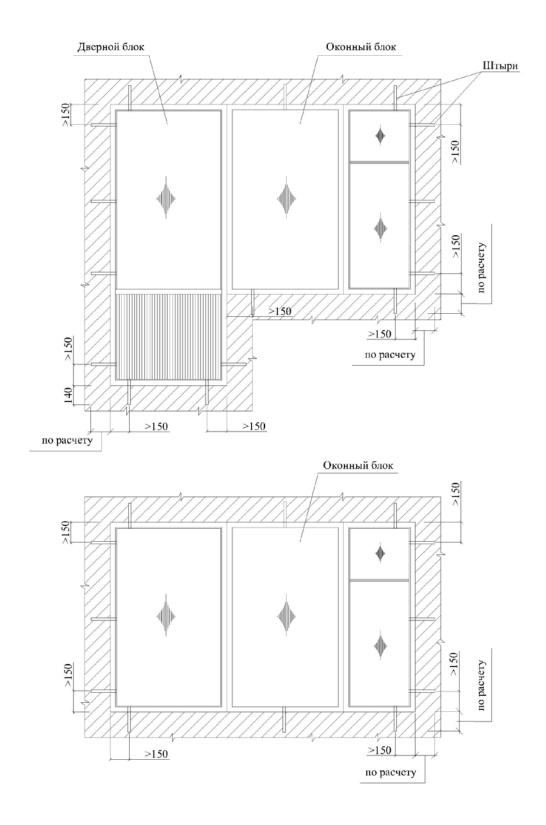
Крепление оконных (дверных) блоков к стенам из полистиролбетона
